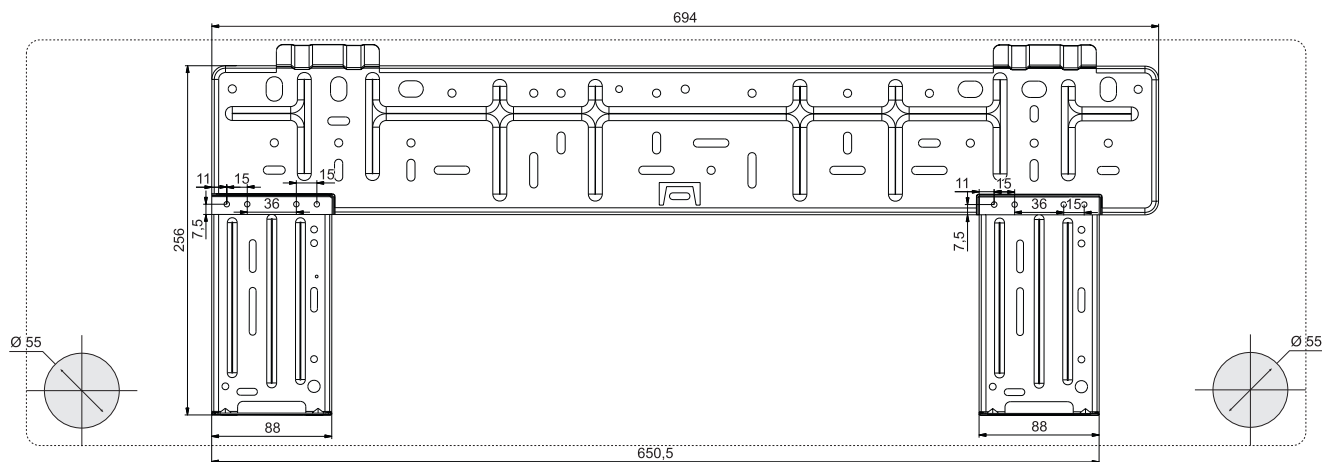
Placa de montagem para VAI 6-050 WMNI.
